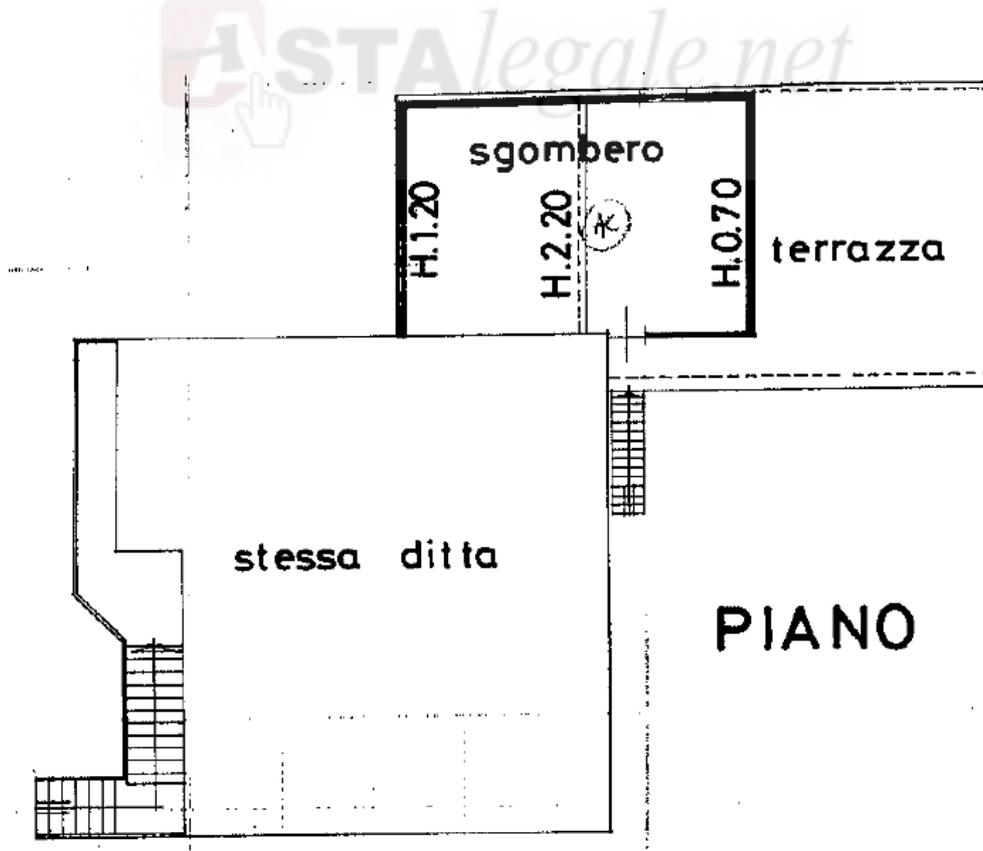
Estratto della planimetria catastale – sub. 1, p.p.
